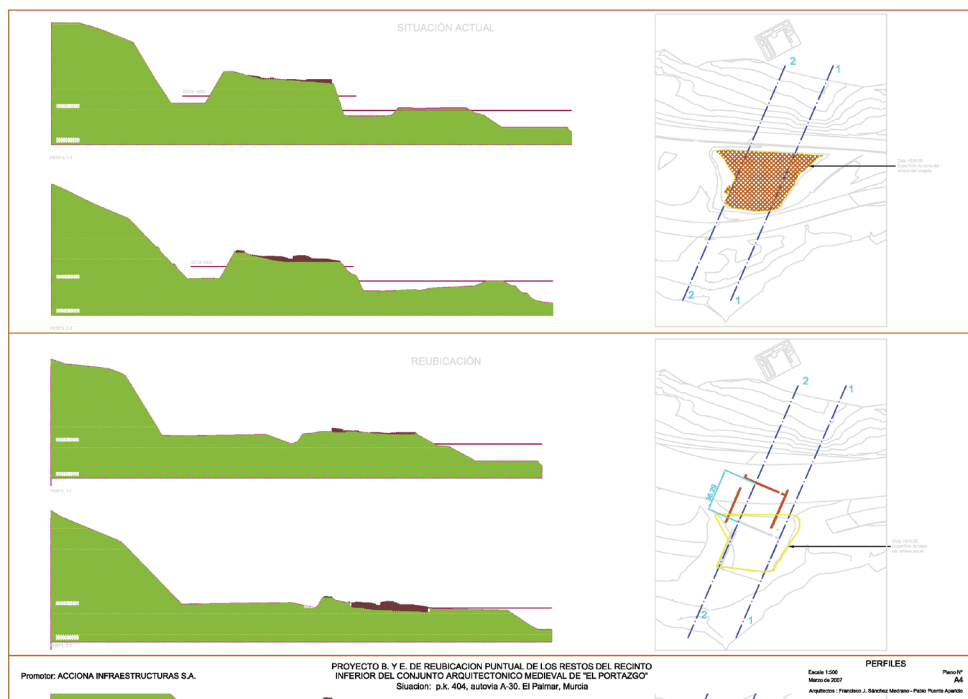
Secciones y plantas que explican el movimiento de traslado de los restos. (2005, Fuente: Proyecto)
